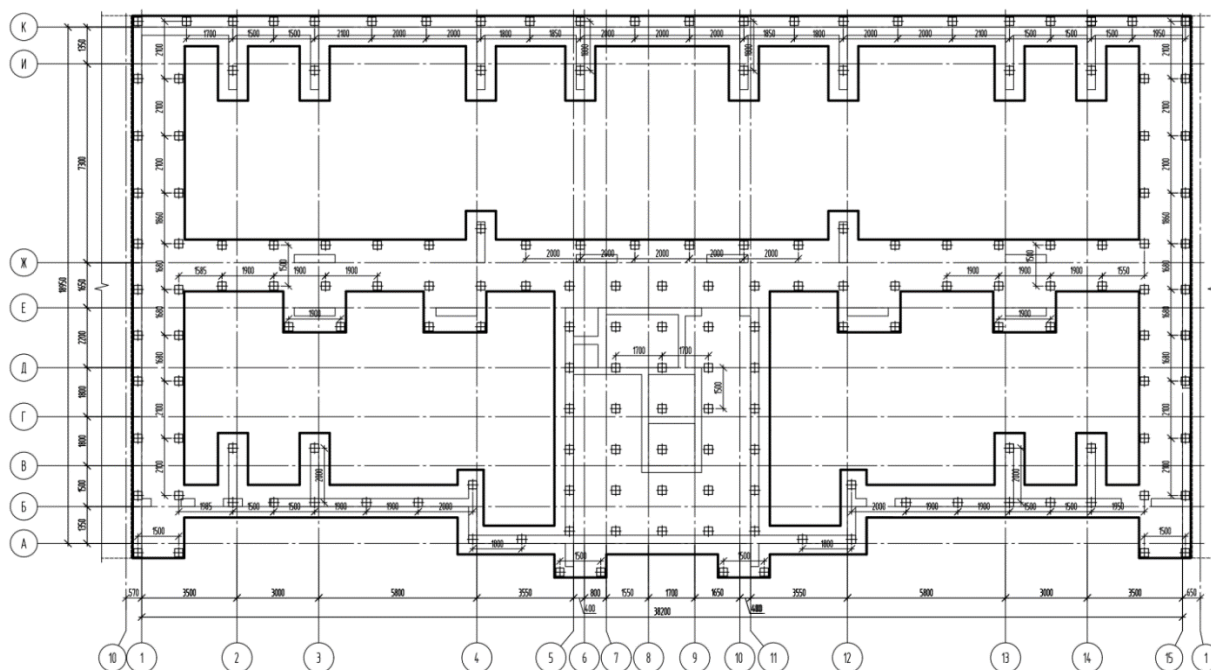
План свайного поля и ростверка по 3-му варианту проектирования
